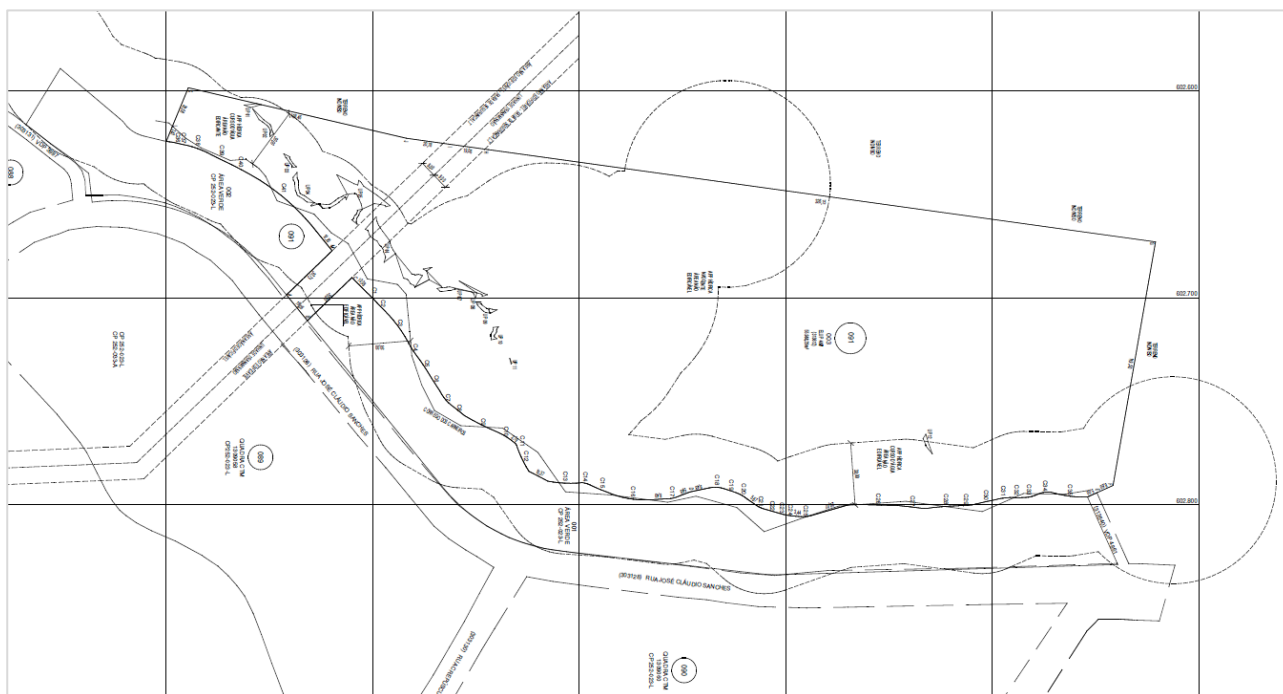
Planta CP 252-074-M - ELUP. Fonte: PBH, 2020.
